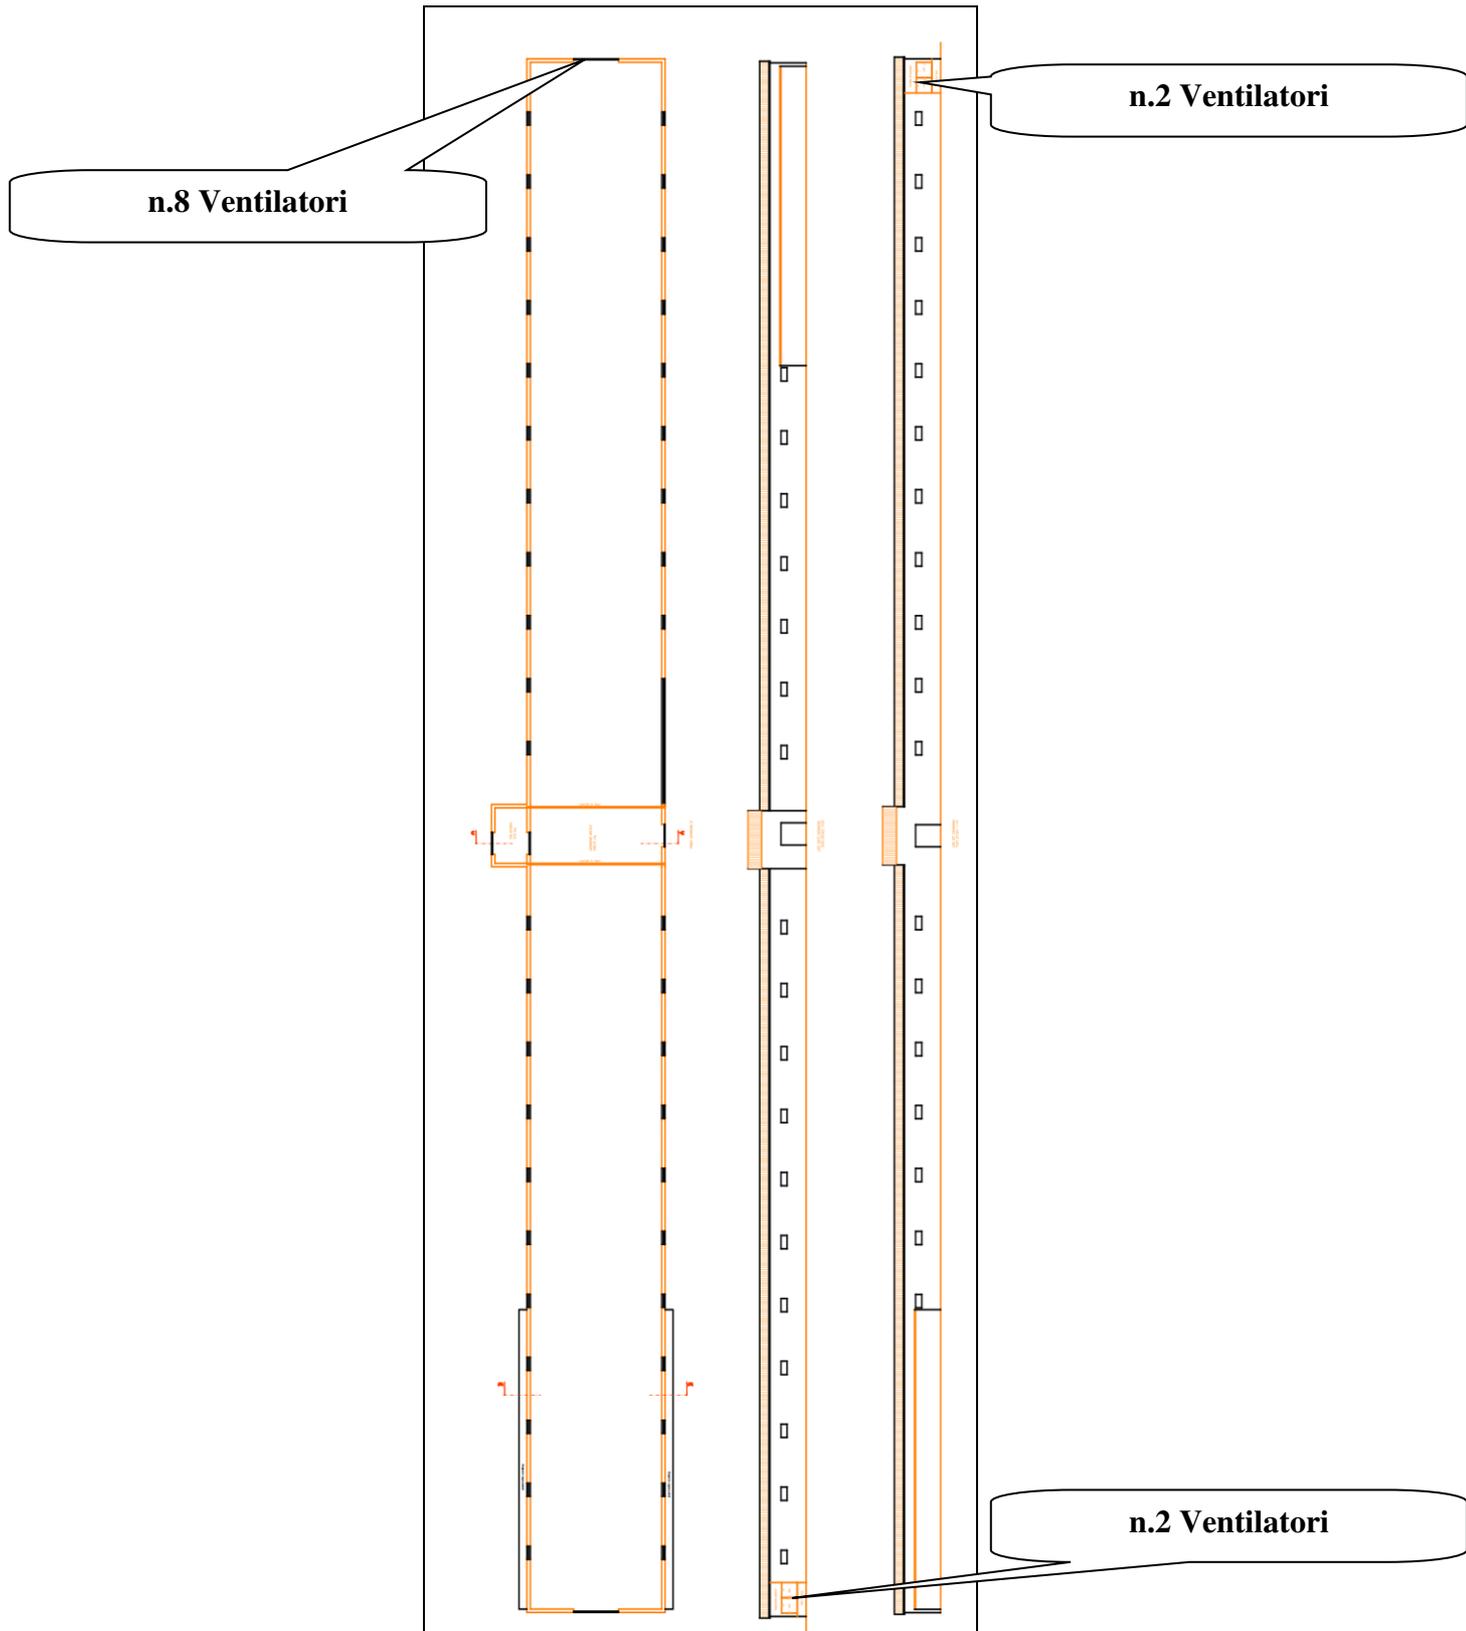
Pianta e prospetti CAPANNONE B stato futuro
